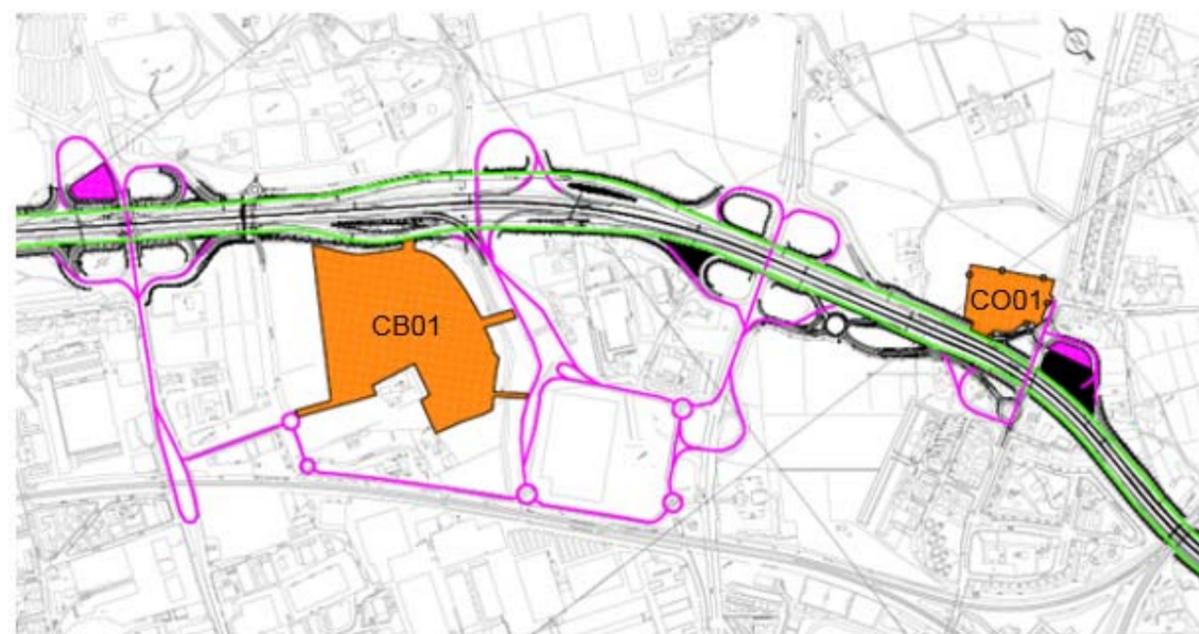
Localizzazione cantieri base (fonte: Progetto definitivo – Cantierizzazione e fasi costruttive)
